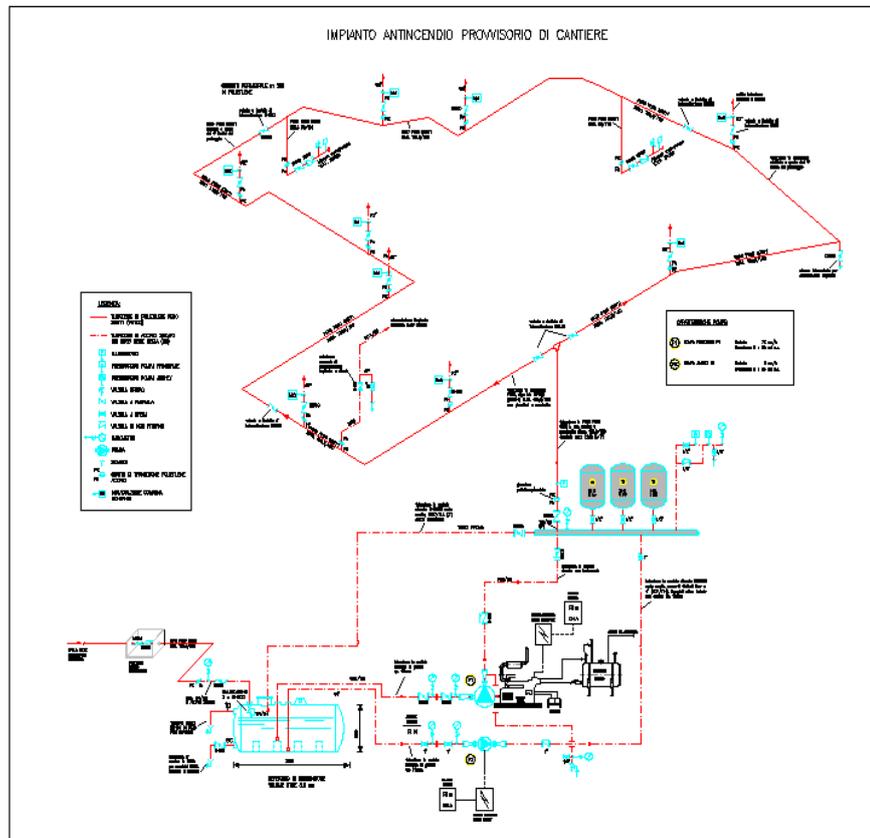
schema altimetrico dell'impianto antincendio provvisorio di cantiere.
